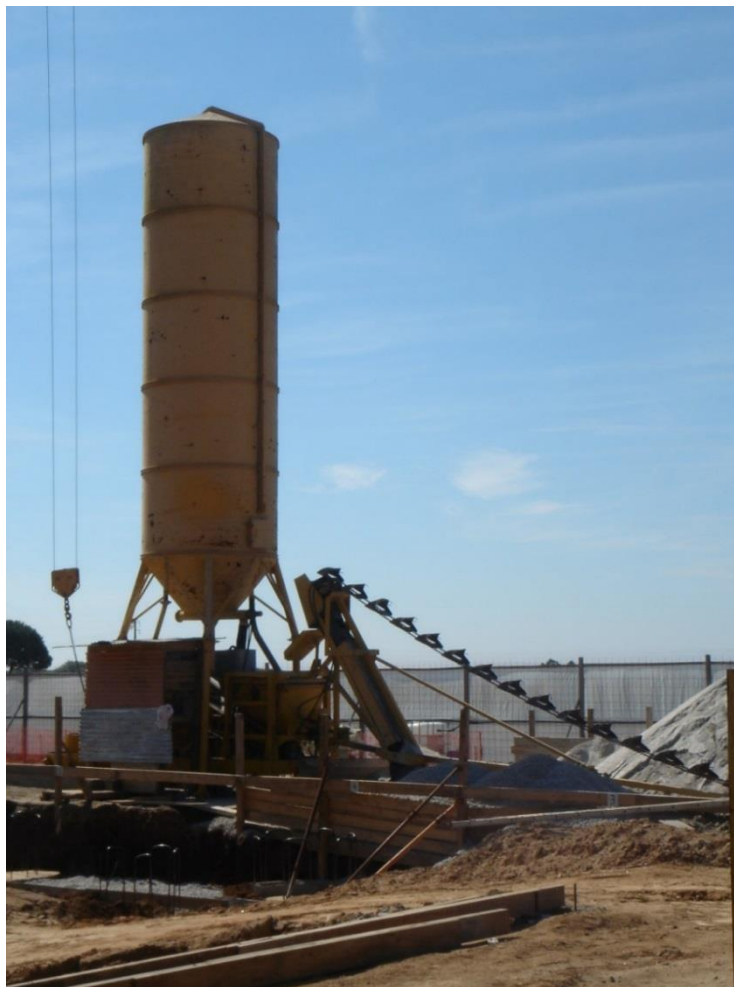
Betoneira em estaleiro (Fonte: Autor)
